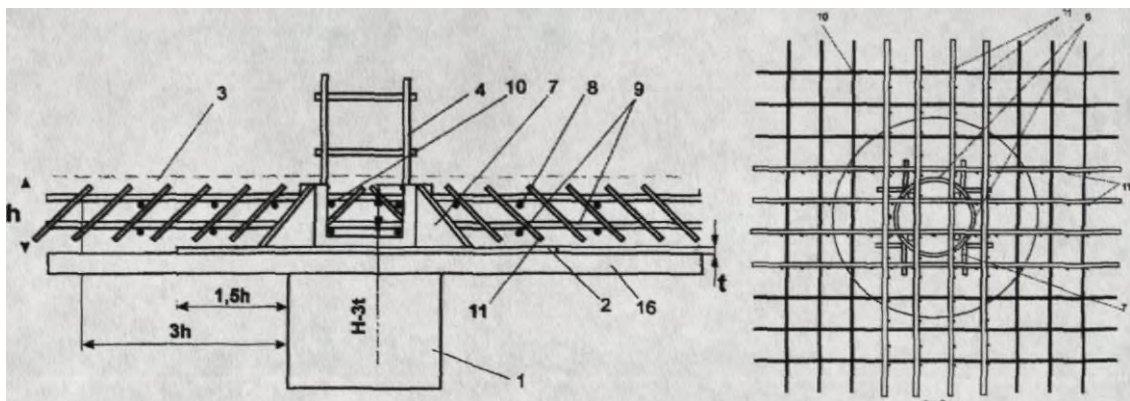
Вузол сполучення колони з плитою перекриття із застосуванням поперечної арматури: 1 - колона; 2 - опорне кільце; 3 - плита перекриття; 4 - арматурний каркас колони; 5 - бетон; 6 - виріз; 7 - косинка; 8 - верхня сітка; 9 - нижня сітка; 10 - арматурний каркас плити перекриття; 11 - похила поперечна арматура
